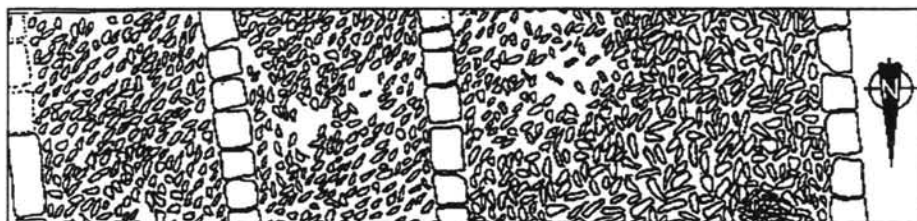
Planimetría del sondeo arqueológico realizado en la vía de Pozazal.
